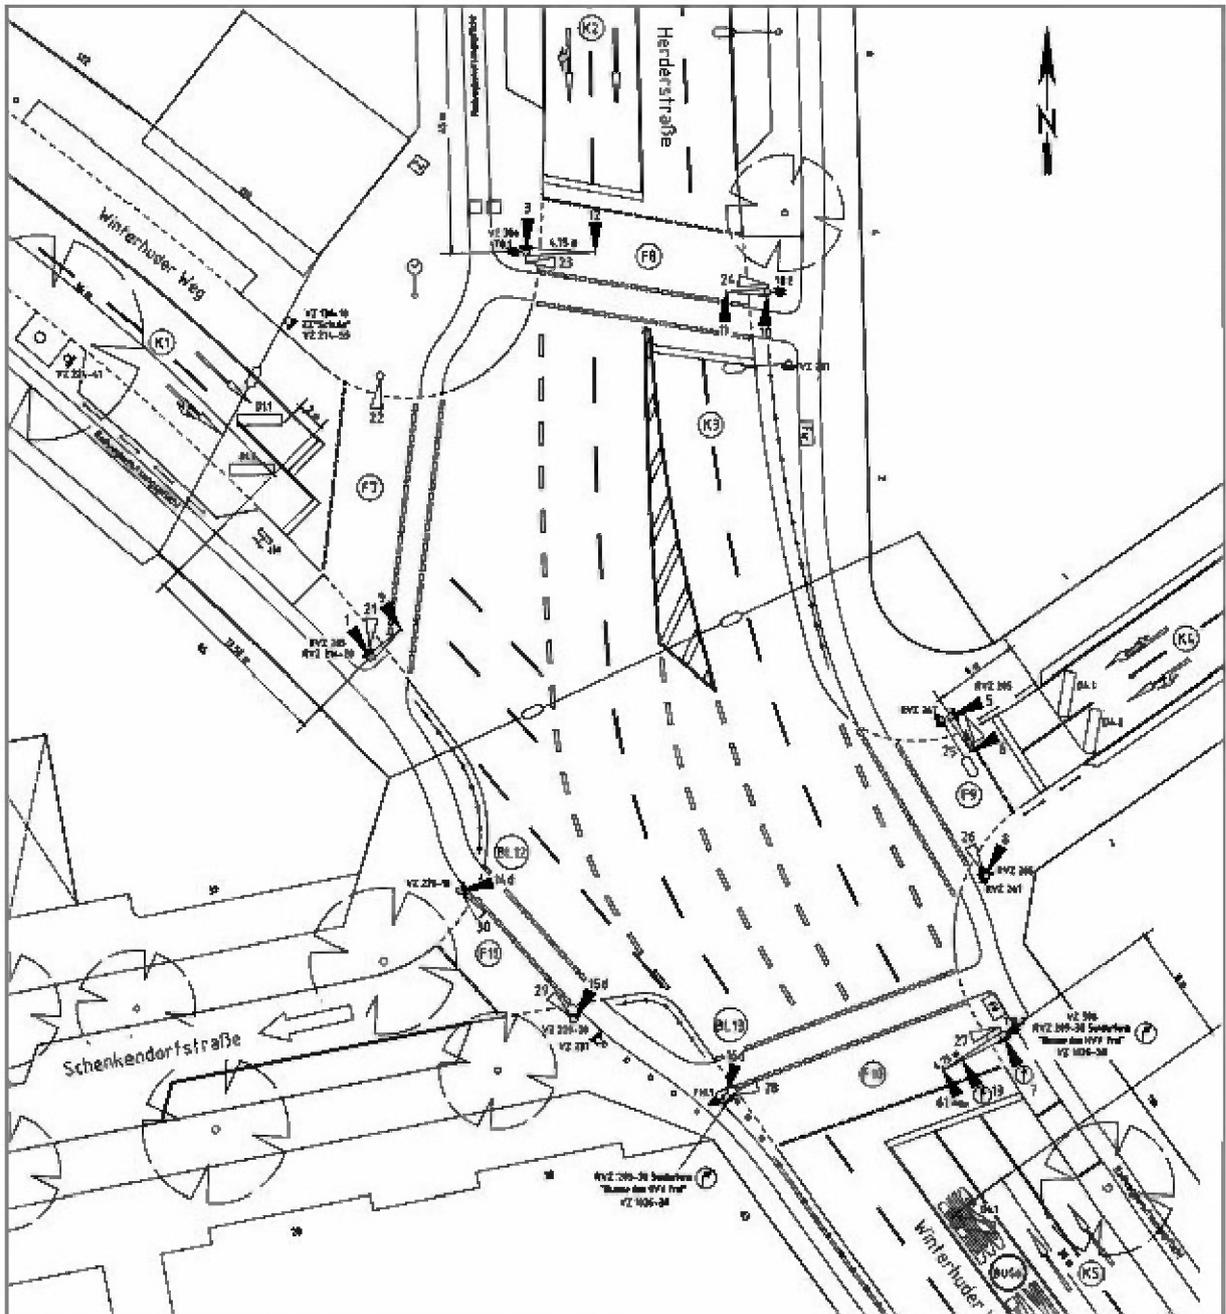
3 Signallageplanausschnitt LSA 218
